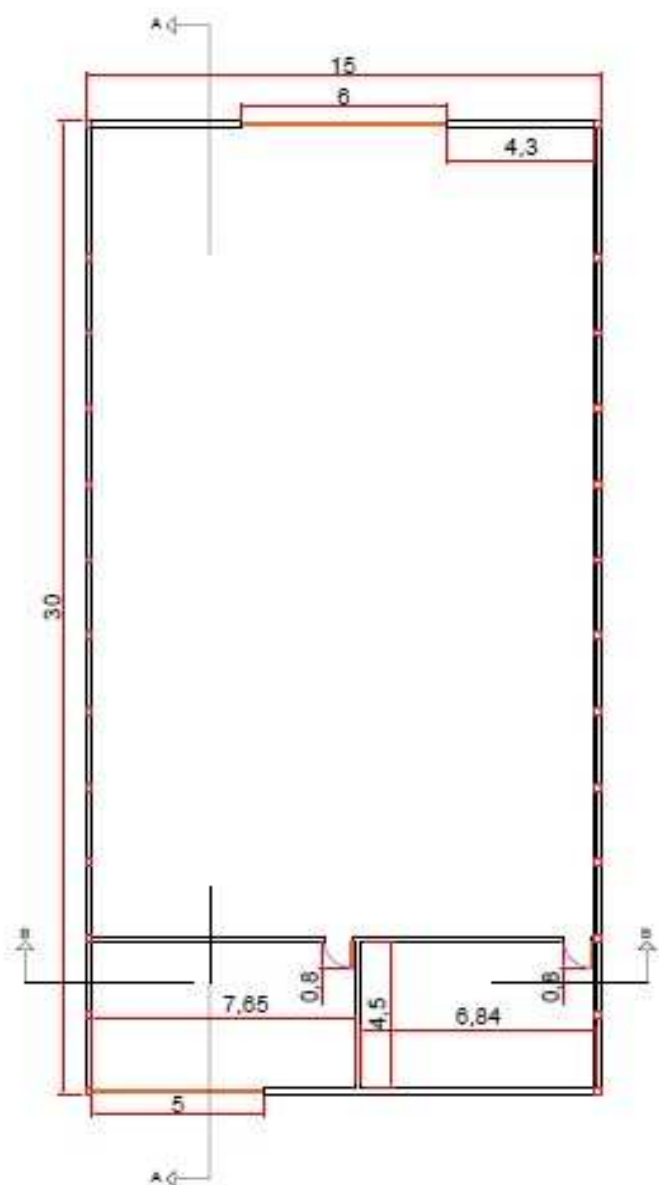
Projeto arquitetônico planta baixa (CAMARGO, 2001).
